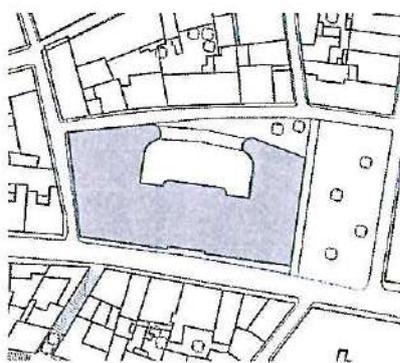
Planta de Implantação da Primeira Versão | Escala 1:2000
